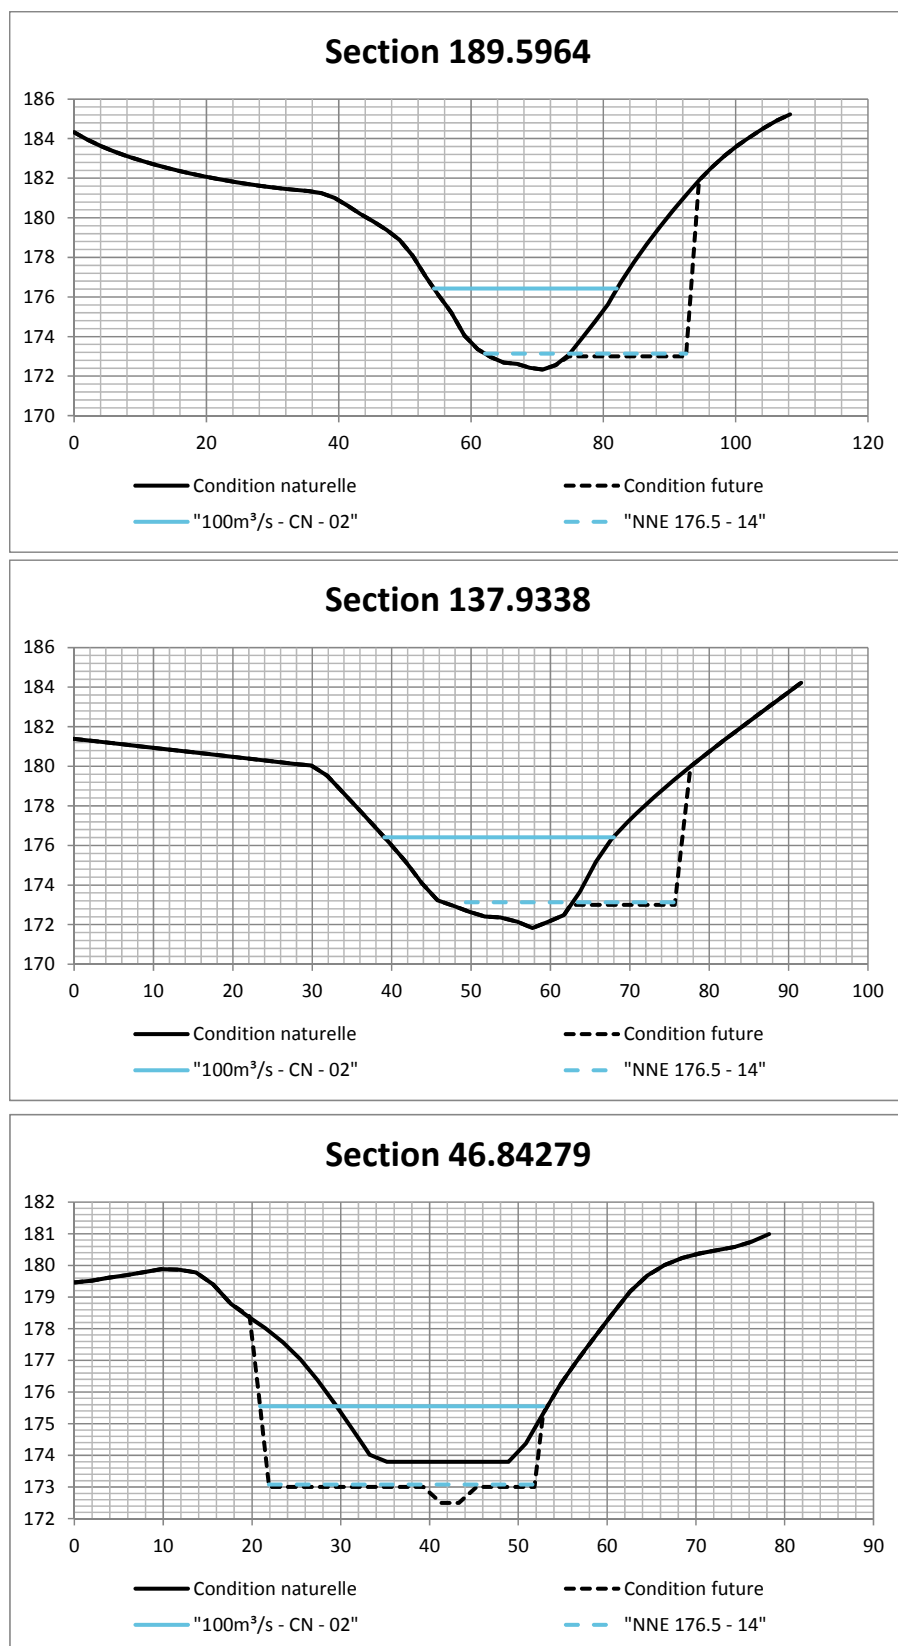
Excavations et niveaux d'eau prévus aux sections transversales du bras Ouest
